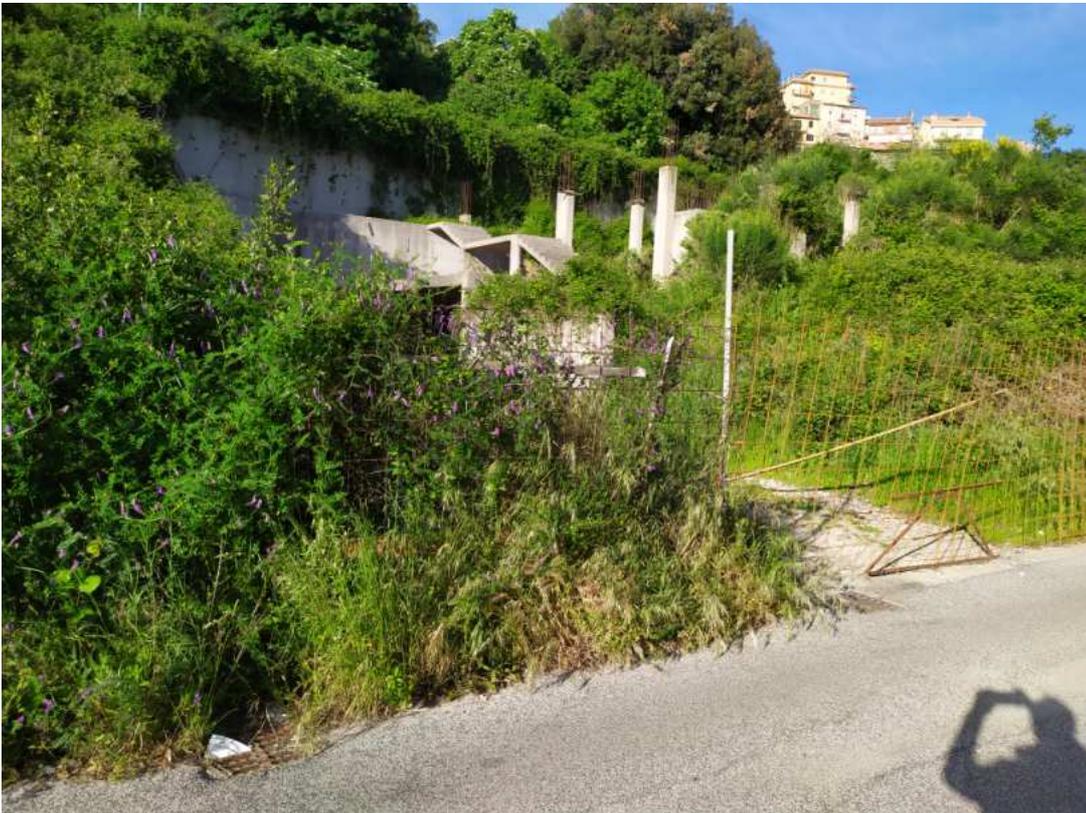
LA SCALA DI COLLEGAMENTO CON I PILASTRI
